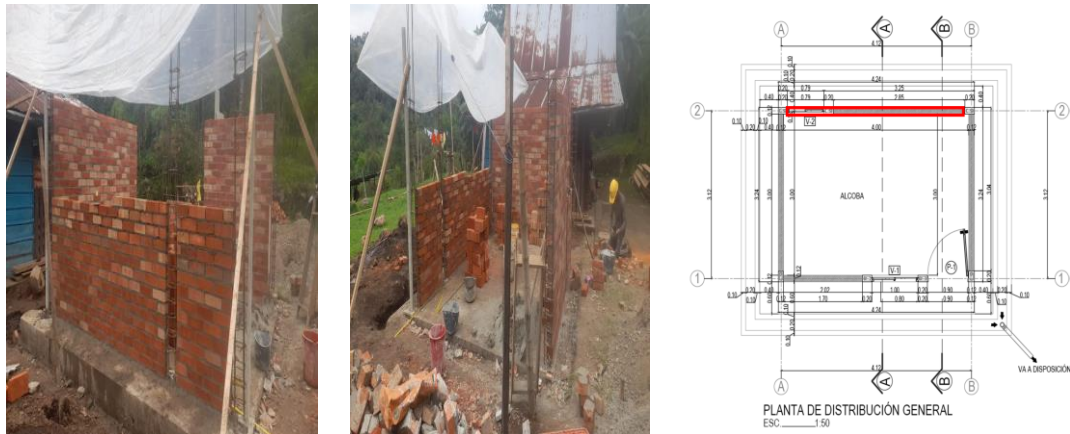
avance mampostería Raúl chantre (alcoba)
